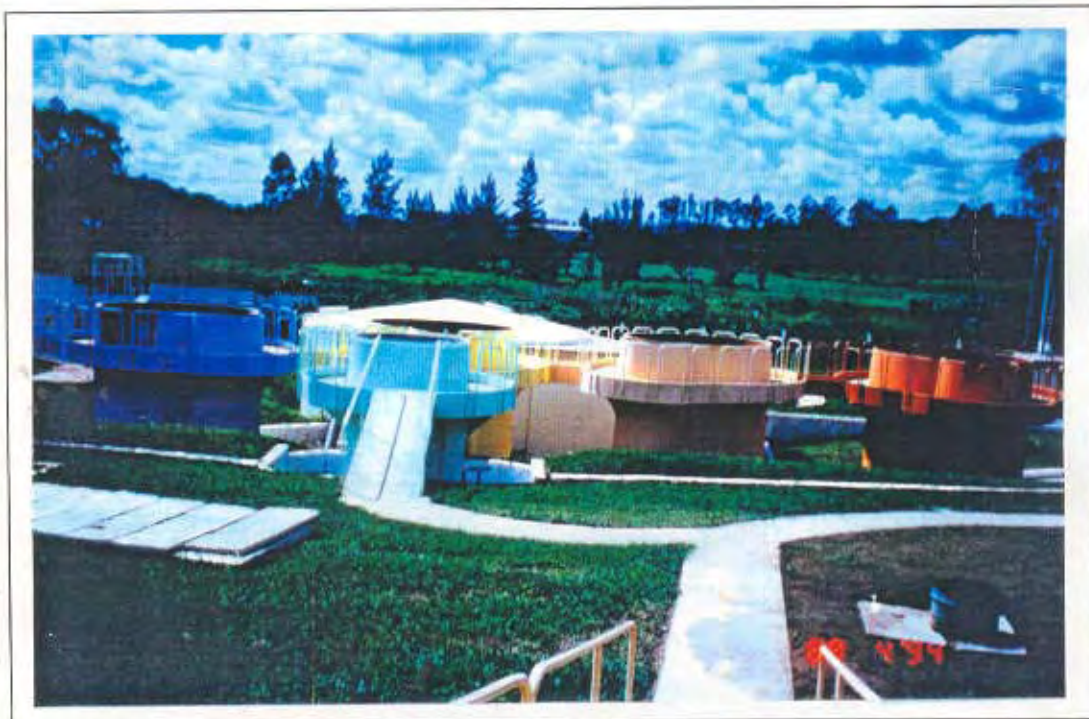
Caja de distribución y batería de filtros de tasa declinante y lavado mutuo.
